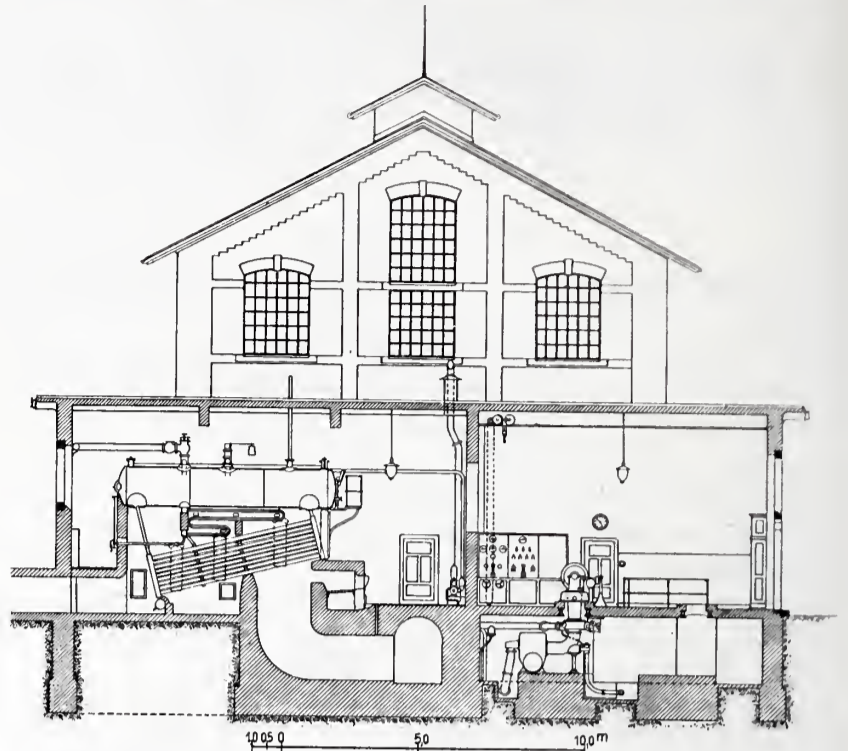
Längenschnitt durch das Kessel- und Maschinenhaus. — 1 : 300.
